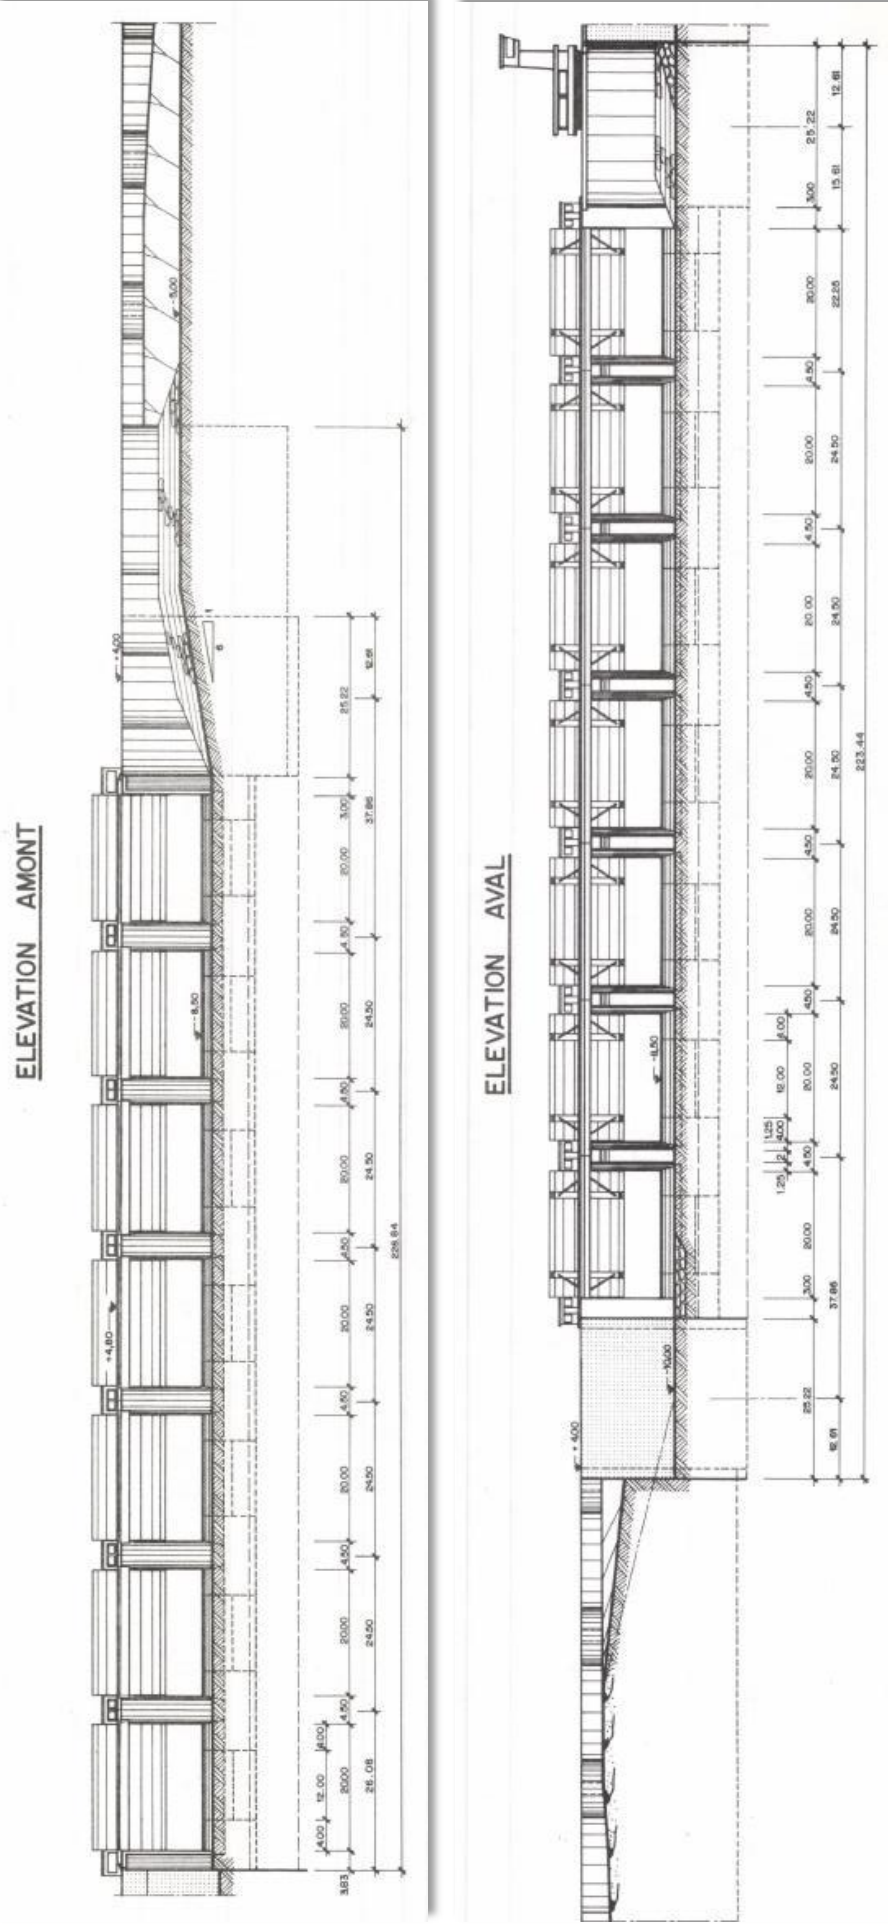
Extraits de plans du barrage de Diama (élevations amont et aval)
